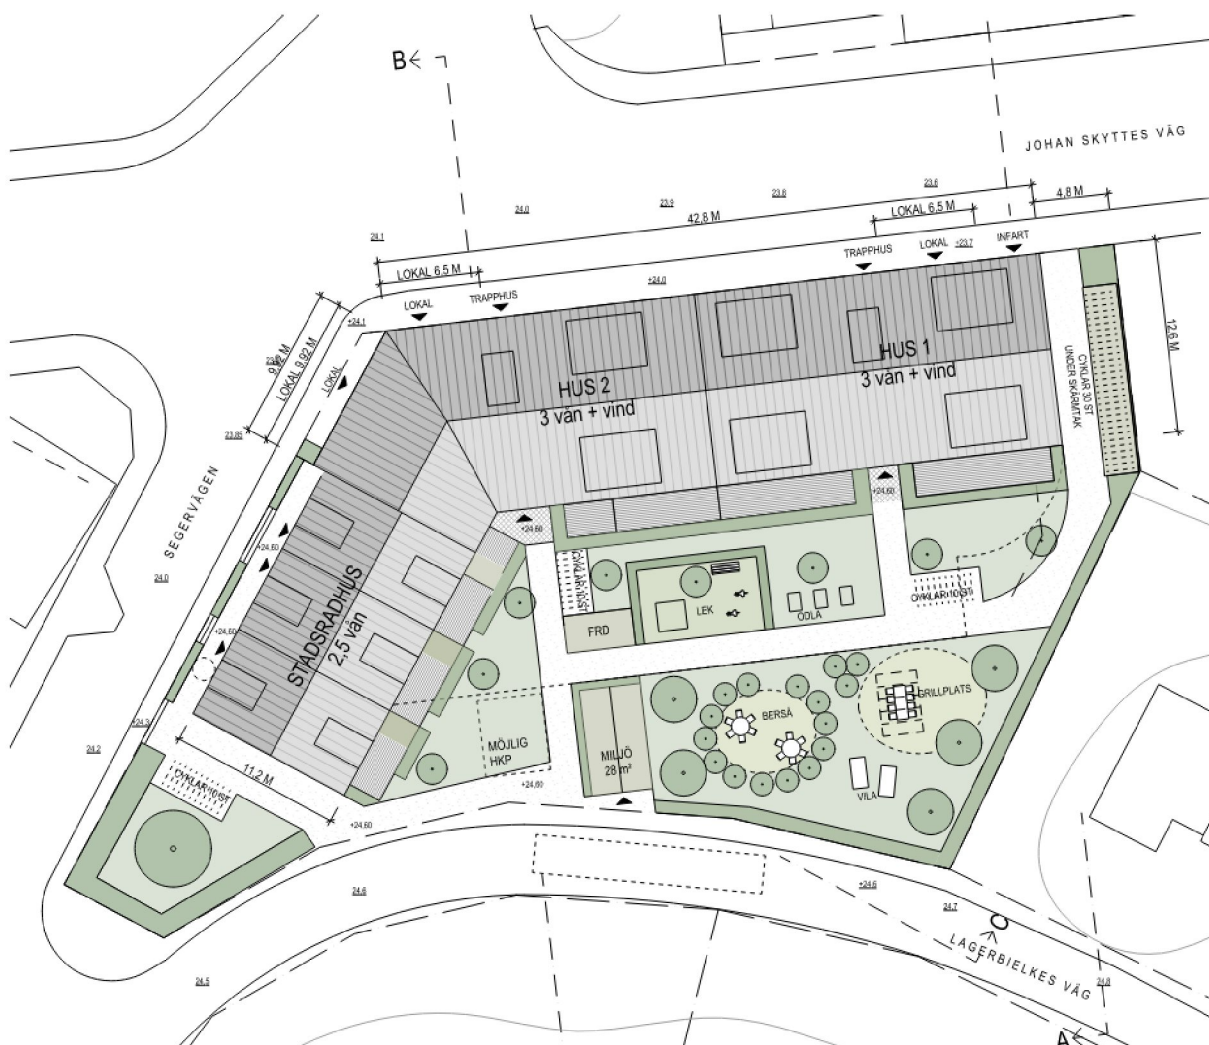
Urklipp ur situationsplan för planerad bebyggelse, Reflex Arkitekter
